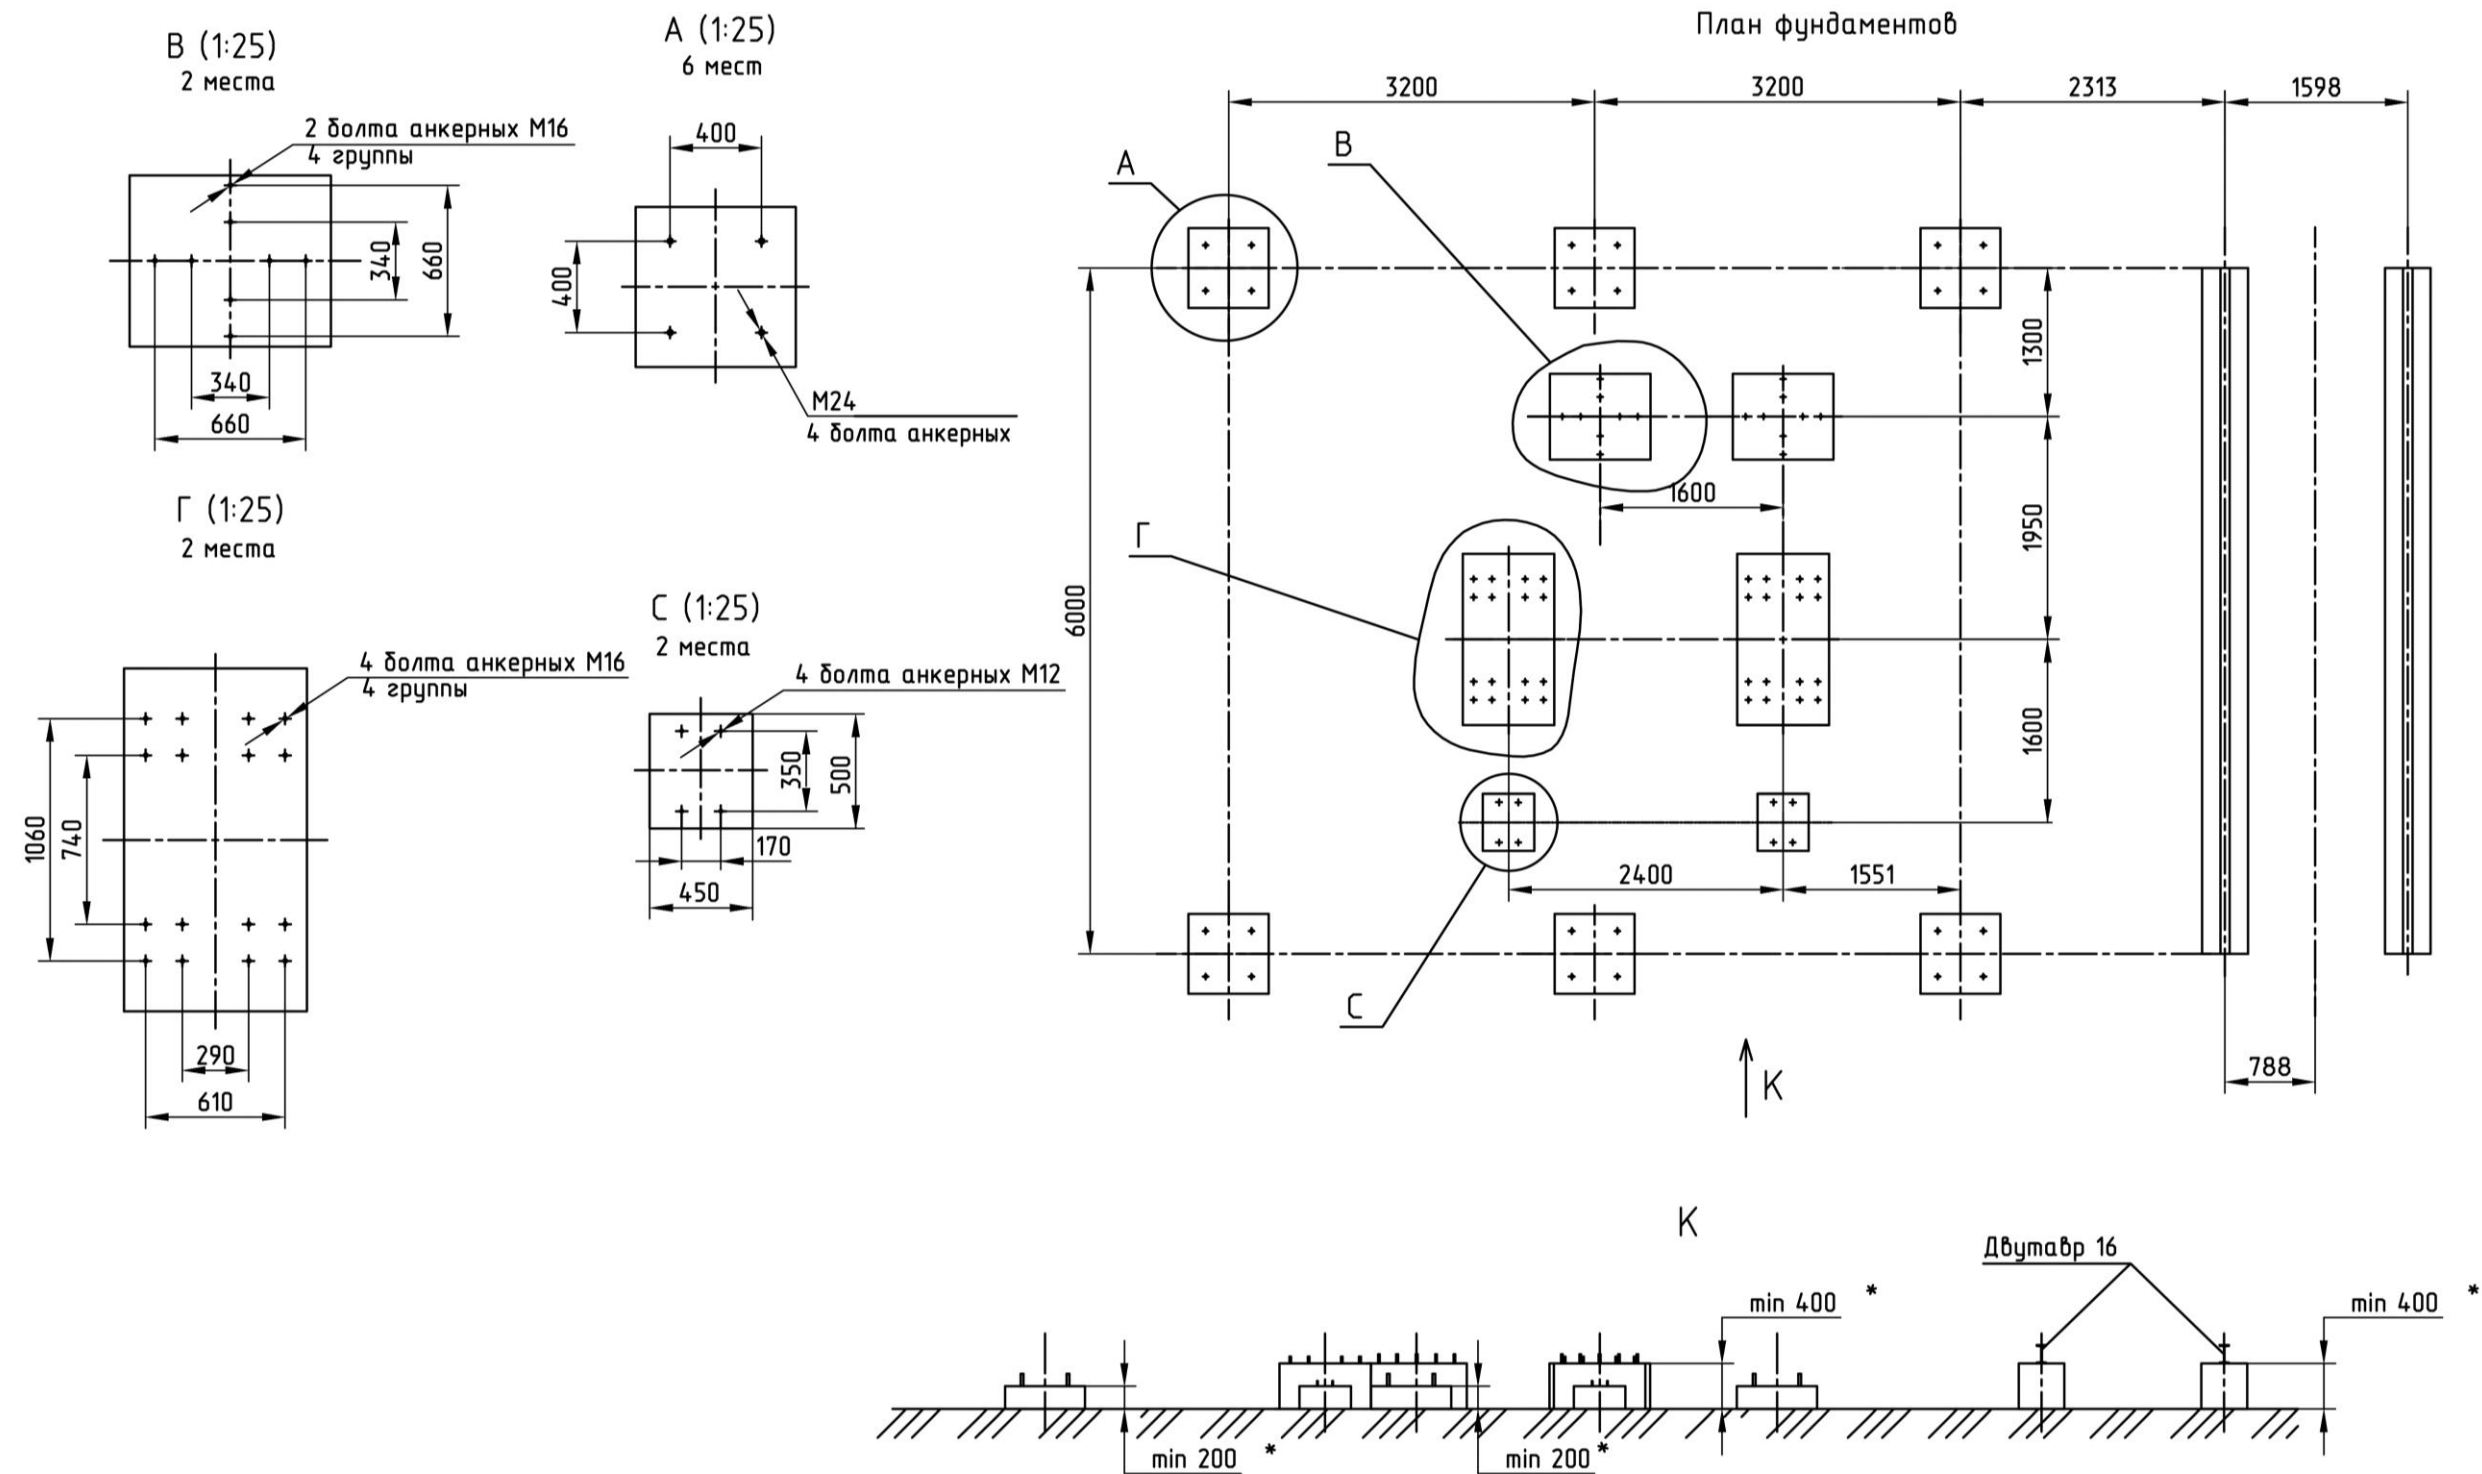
План фундамента для УПК-25 кВ-1600 А У1
